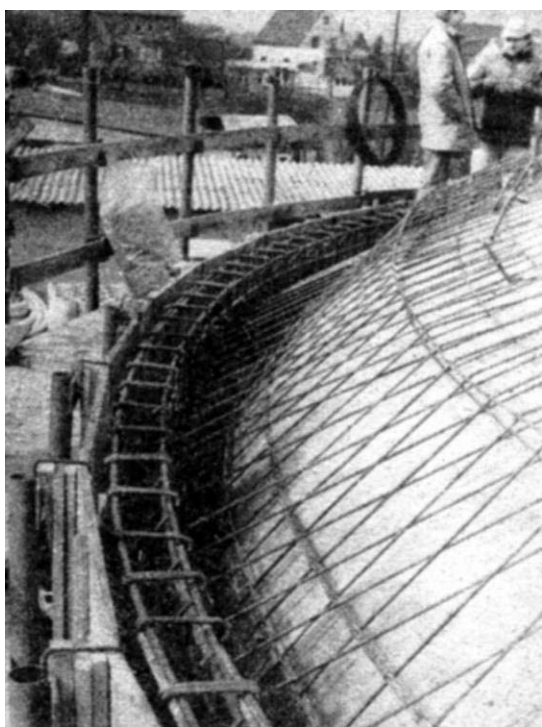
Опалубочная конструкция из 28 GYP- элементов
